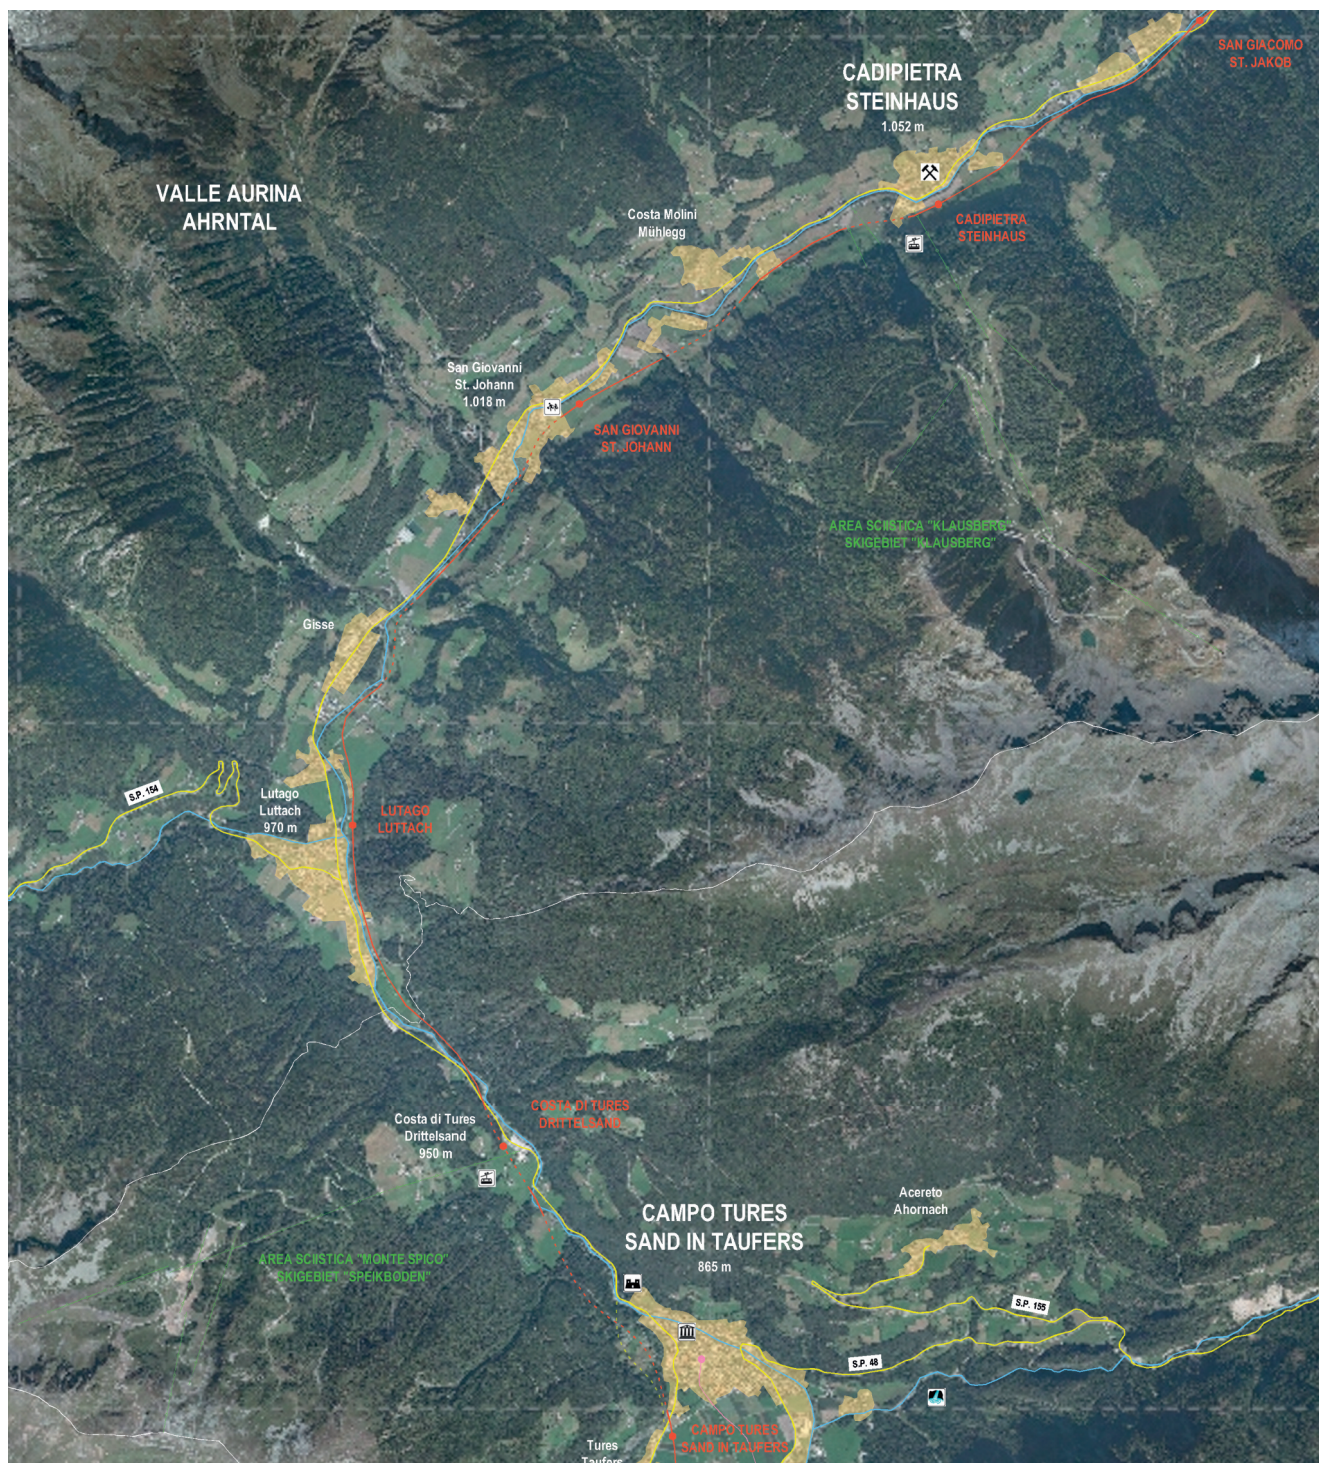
Andamento planimetrico lotto 2, Campo Tures-Cadi Pietra.
